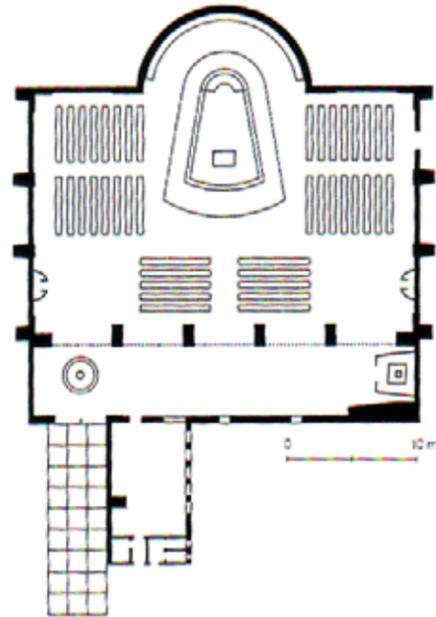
Taufbecken im Eingangsbereich, Grundriss St. Laurentius, München
